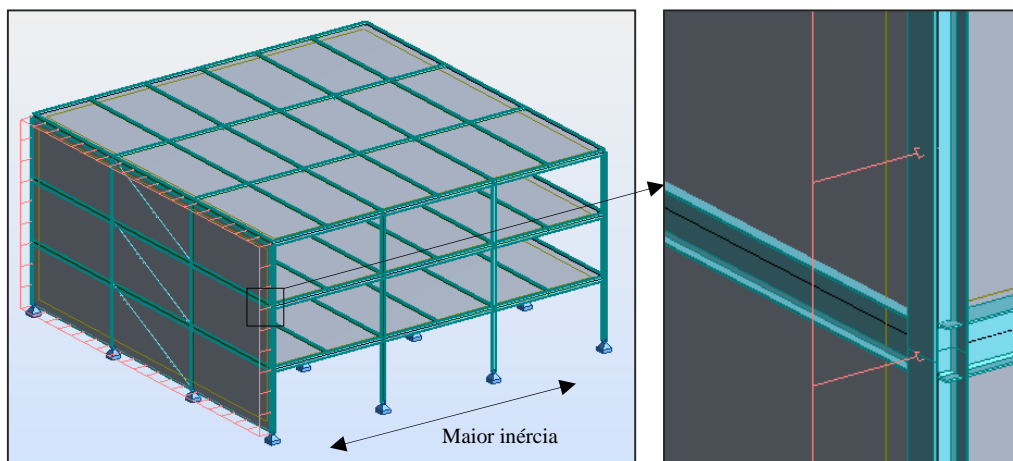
Carga uniformemente distribuída de 1 kN/m^2 numa fachada de maior inércia.
